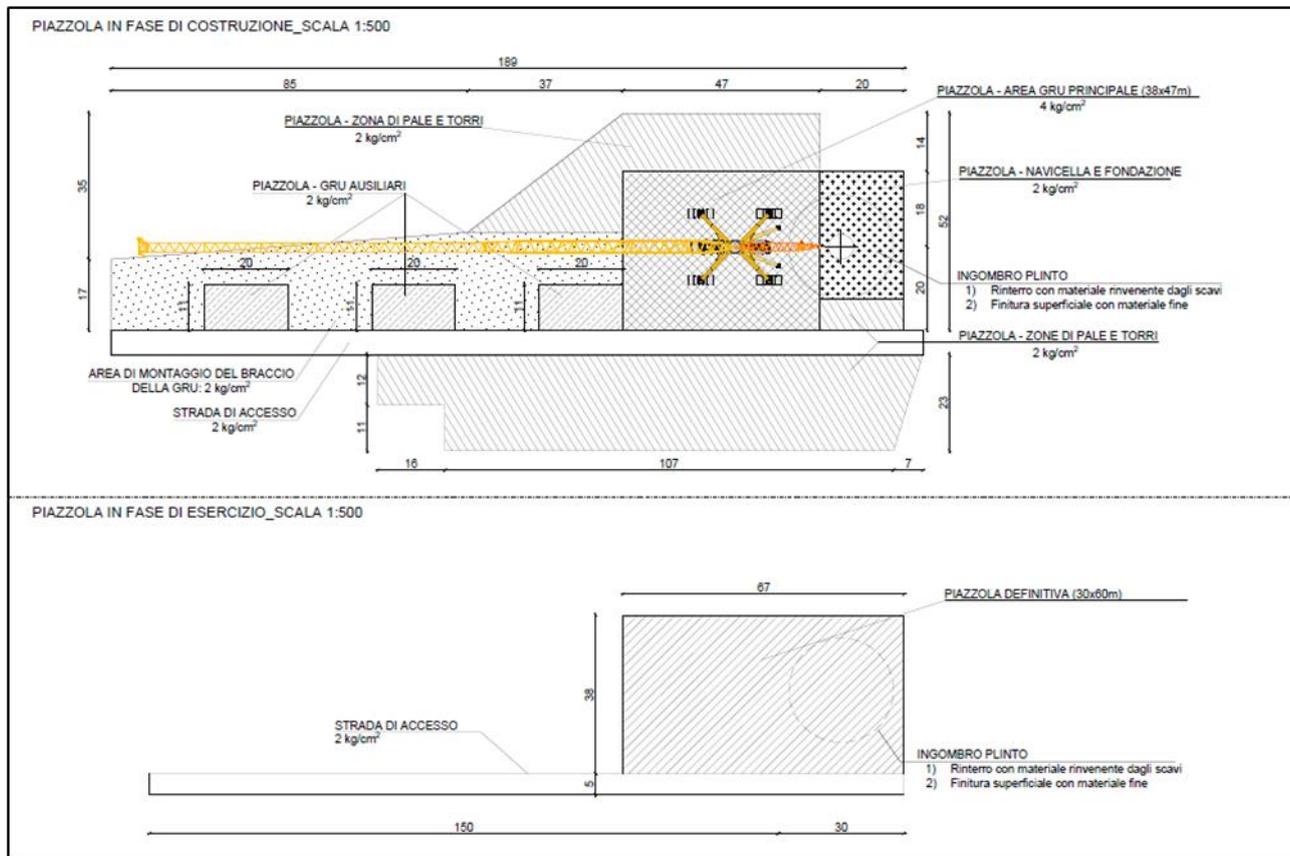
Planimetria piazzola tipo per la fase di installazione e fase di esercizio e manutenzione
